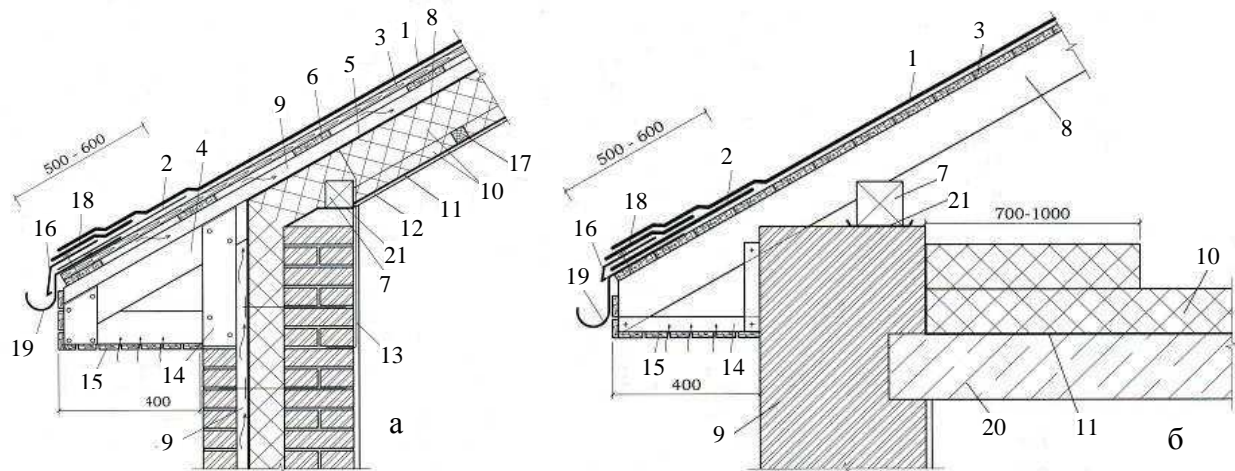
Схема карнизного вузла даху із гнучкої черепиці: а – мансардний поверх; б – холодне горище; 1 – гнучка черепиця; 2 – підкладний шар; 3 – суцільний настил; 4 – кобилка; 5 – повітрязахисна дифузійно-гідроізолювальна плівка; 6 – лати; 7 – мауерлат; 8 – кроква; 9 – вентиляційний проміжок; 10 – теплоізоляція; 11 – пароізоляція; 12 – гіпсокартон; 13 – анкер кріплення крокви та мауерлата; 14 – каркас карнизного звису; 15 – підшивка; 16 – крапельник; 17 – бруски; 18 – карнизна черепиця; 19 – ринва; 20 – плита перекриття; 21 – гідроізоляція
